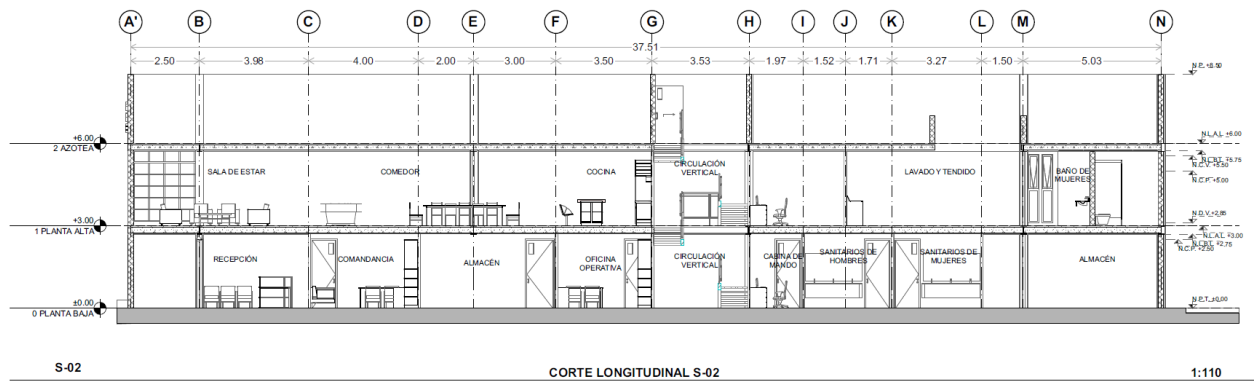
Corte longitudinal S-02. Anteproyecto. Fuente: propia.
